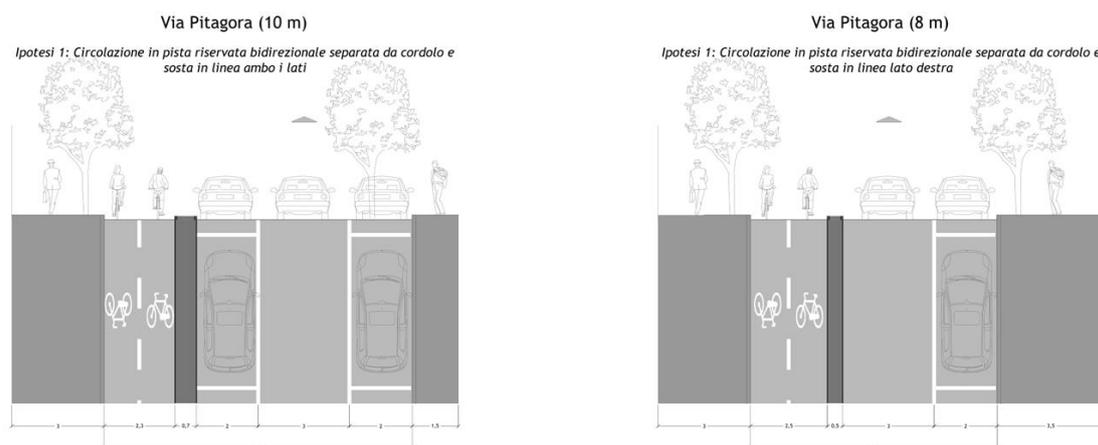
Sezione Via Pitagora - Ipotesi di progetto
